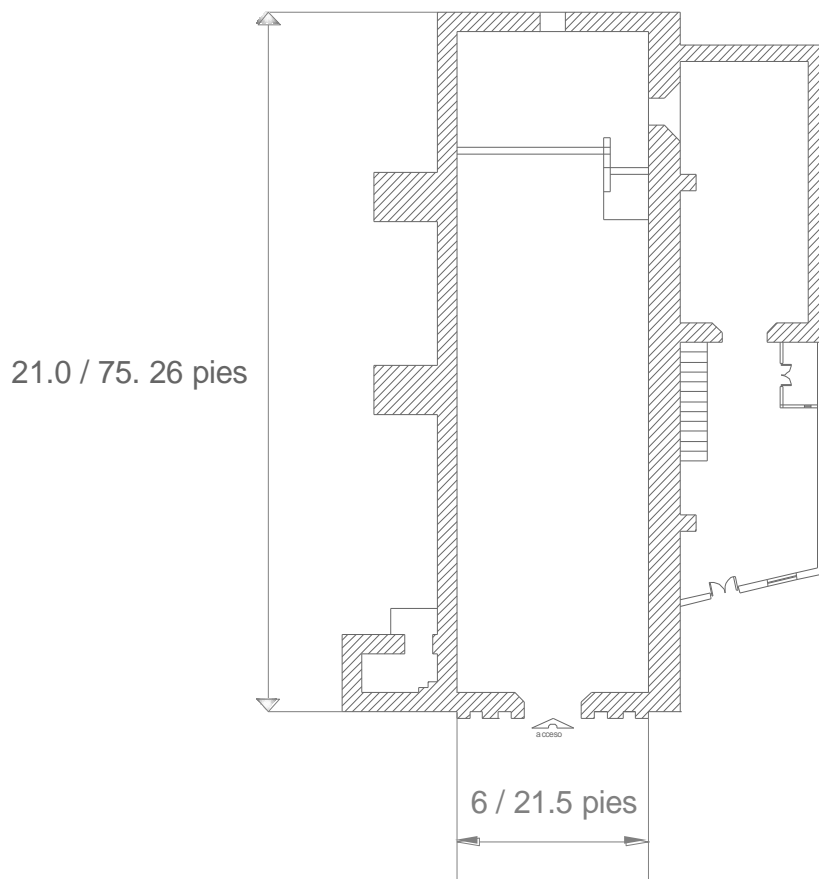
Planta Arquitectónica mostrando las medidas de medición implementadas en estas capillas
